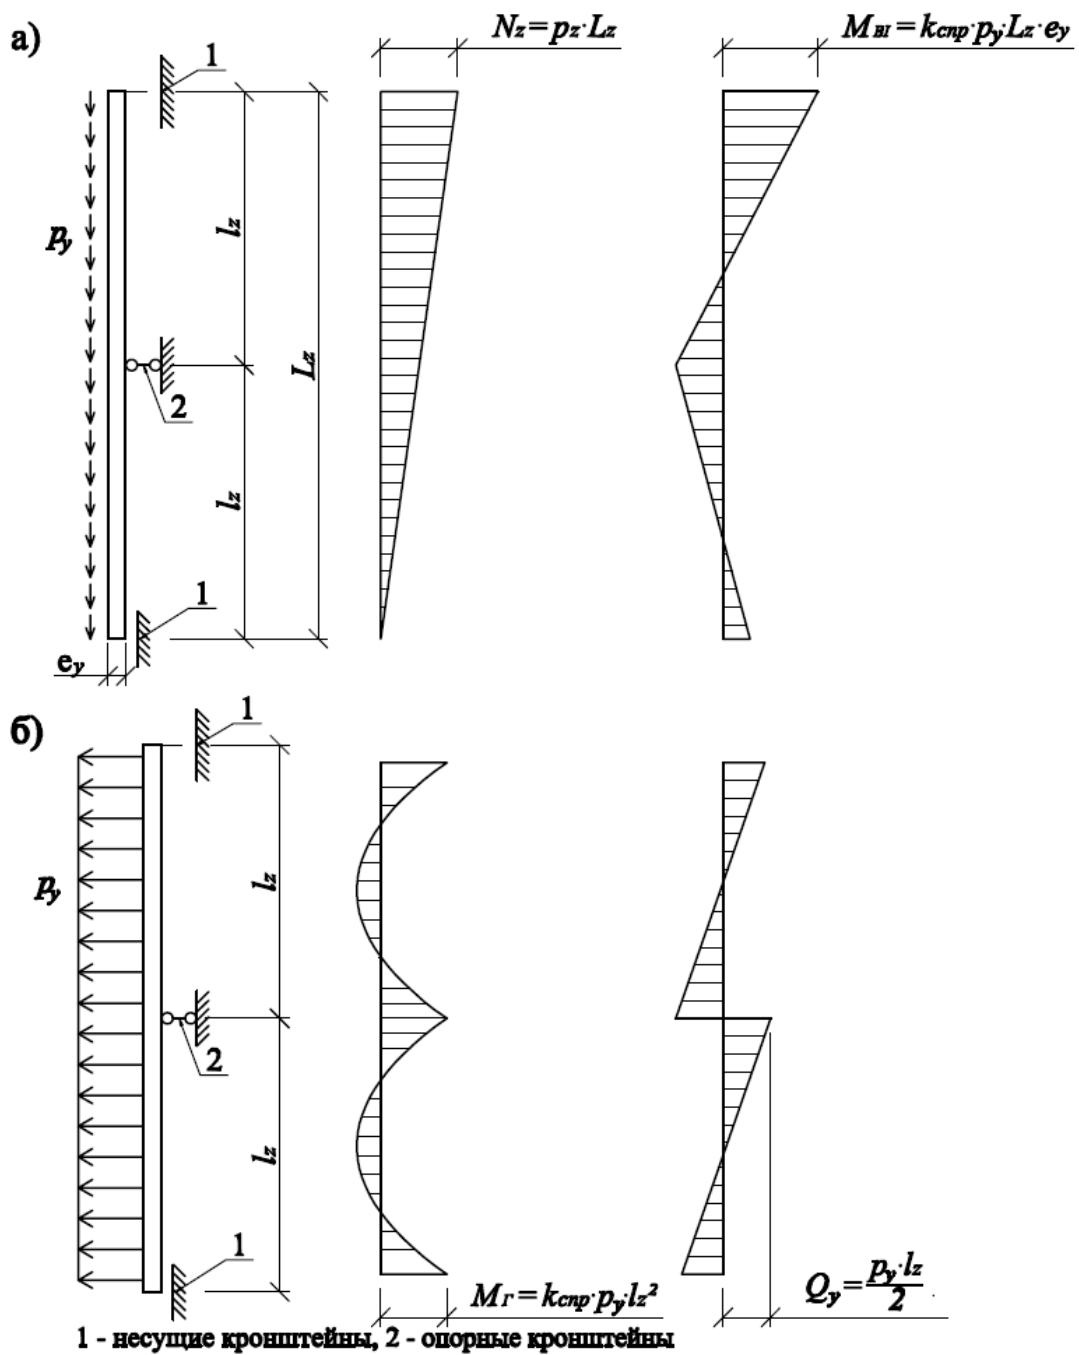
Расчетные схемы вертикальных профилей:
